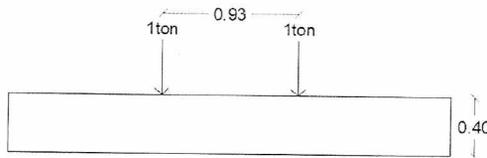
Vista longitudinal de losa con cargas por apoyo
